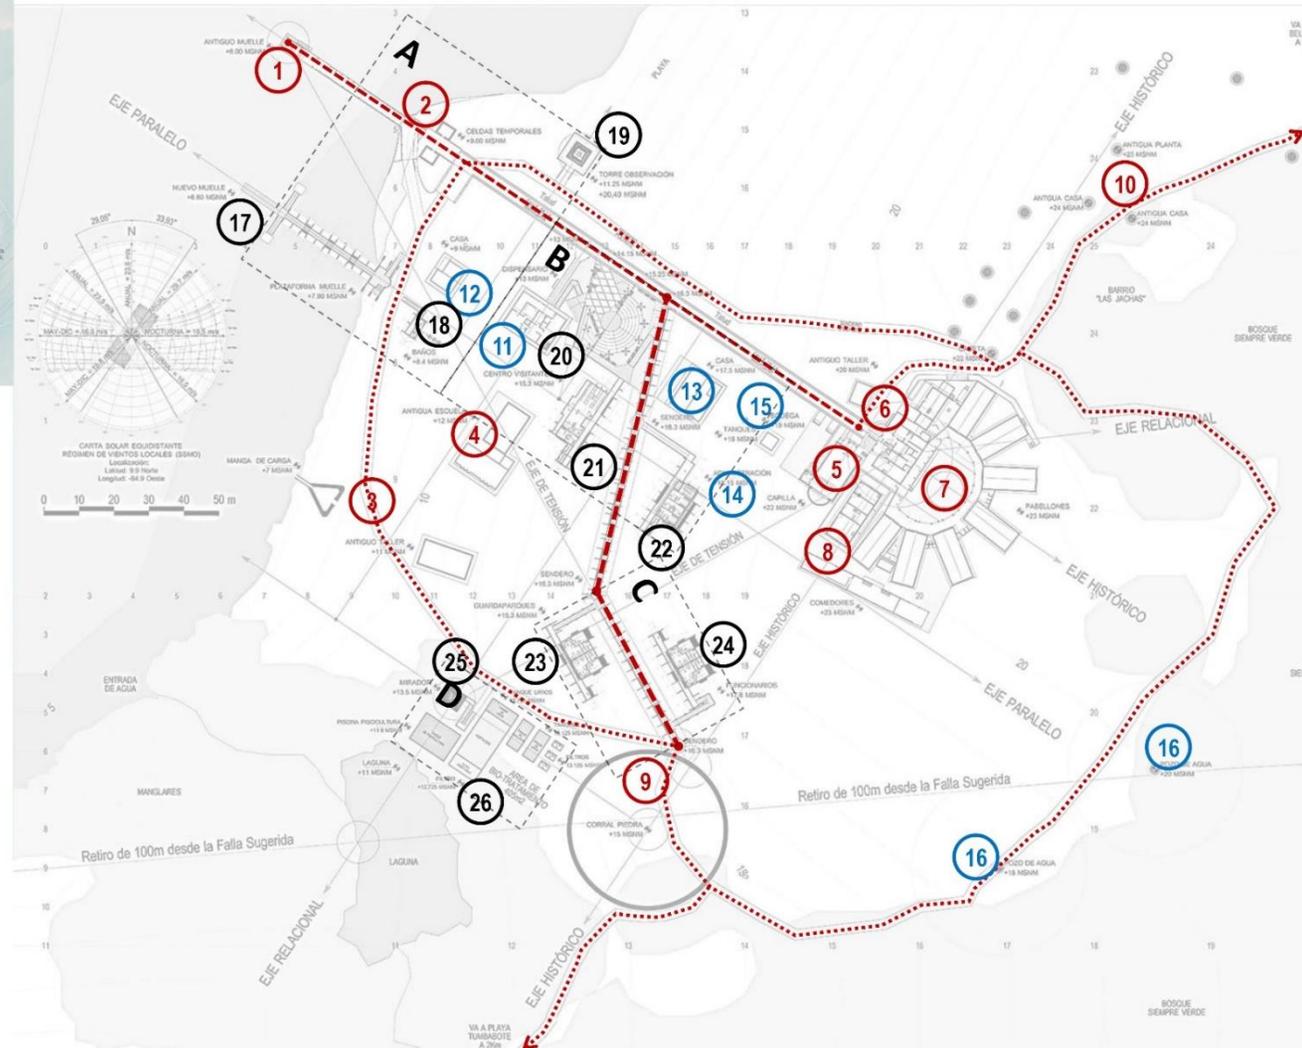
Planta de Zonificación de la Propuesta (2014). Elaboración propia
